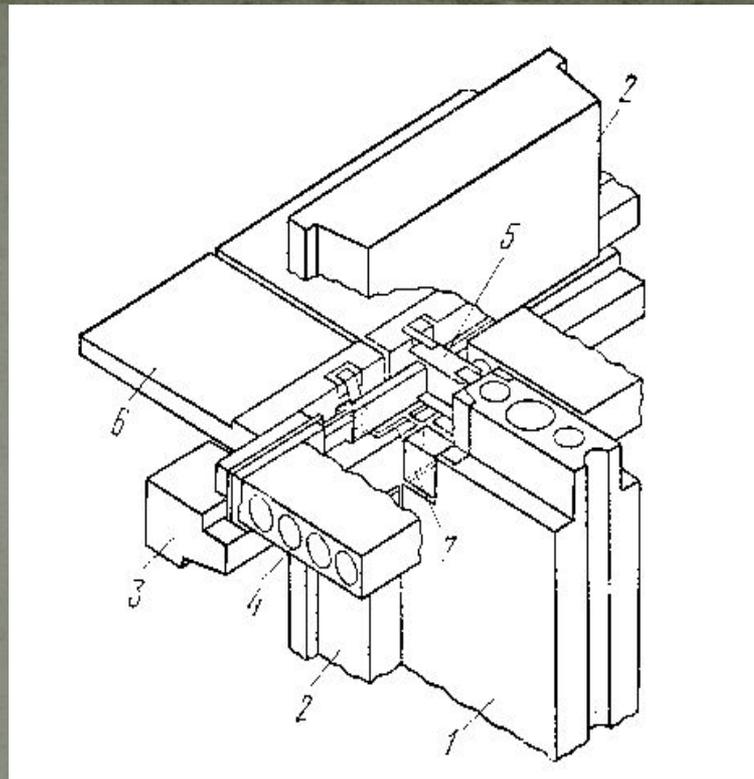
Узел сопряжения несущих конструкций 14-этажного крупноблочного здания: 1- поперечные несущие стены; 2 – керамзитобетонный блок наружной стены; 3 – перемычный блок; 4 – настил; 5 – стальная шпонка; 6- балконная плита; 7 – стальная накладка.
